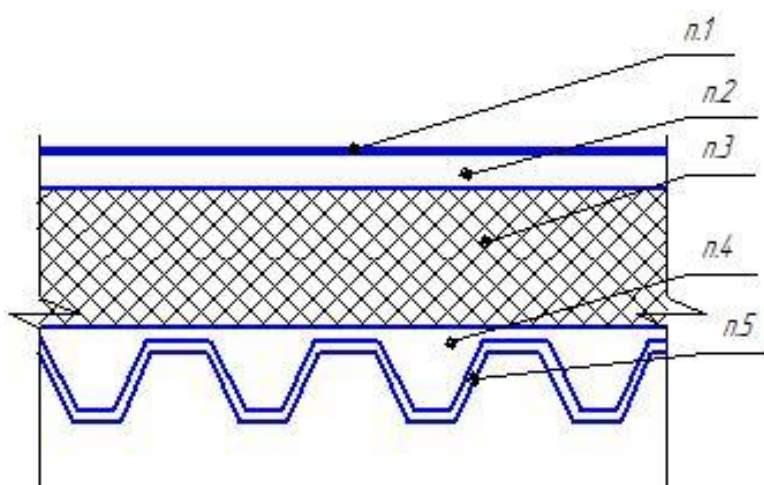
Схема покрытия (кровля)
